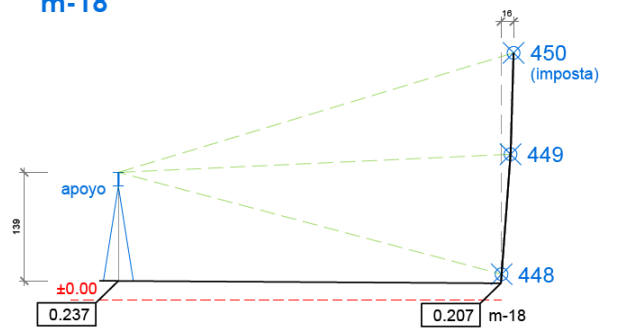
Levantamiento de muro Sur de la nave (elaboración propia).
